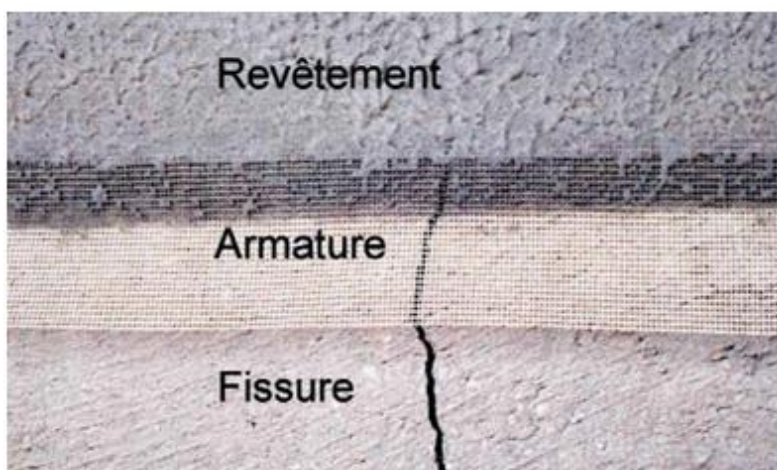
18: pontage d'une fissure intégrant une armature de renforcement [17]
